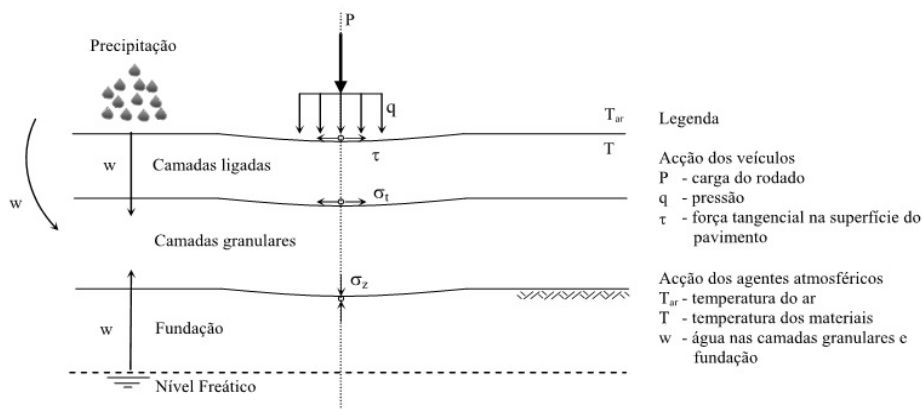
Pavimento rodoviário: constituição e ações (Santos *et al*, 2011)
